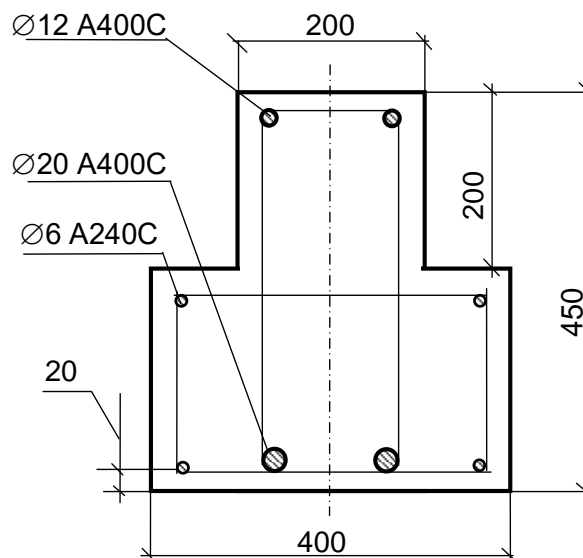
Схема армування перерізу та геометричні розміри залізобетонного ригеля-зразка для випробування
